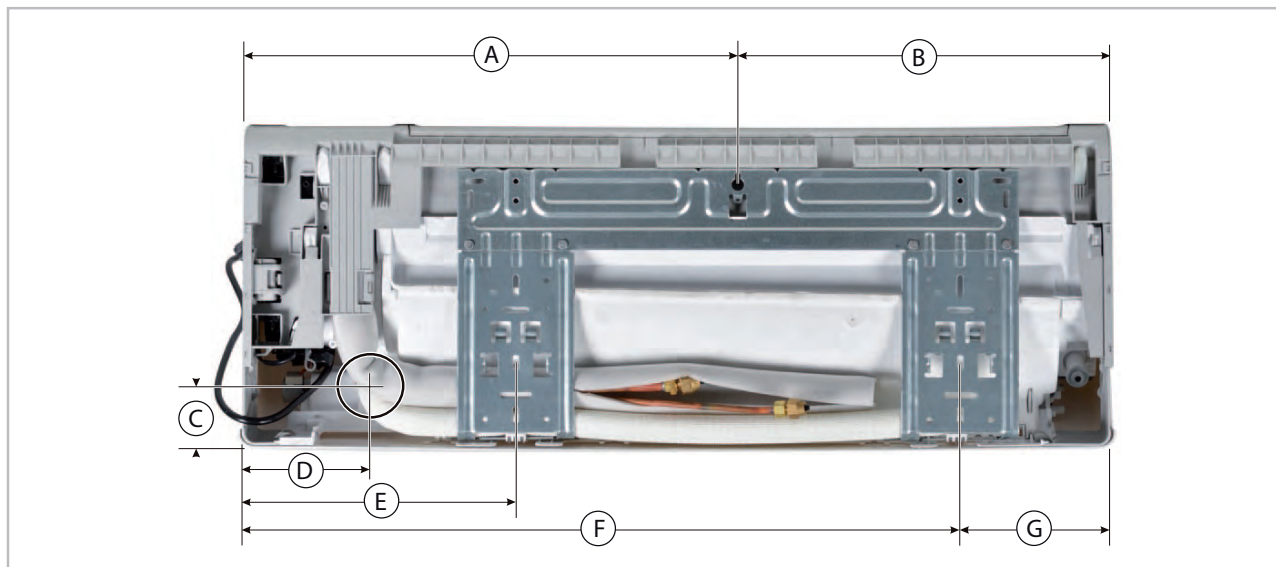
Montagepunkte der Wandhalterung RVT 264-684 DC (Rückansicht)
